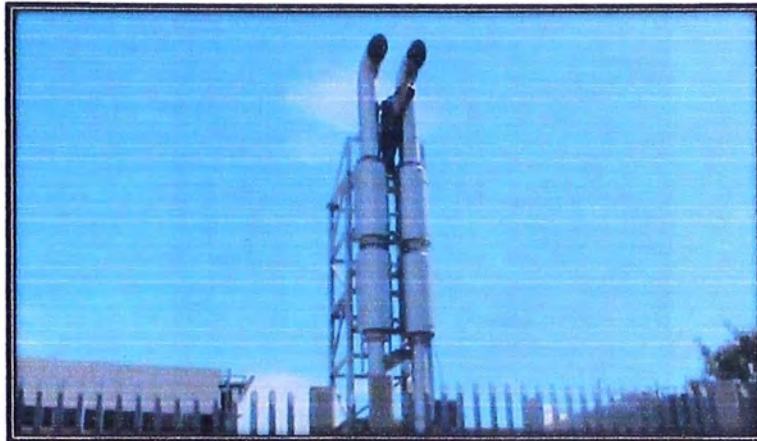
Culminación de montaje de primera y segunda línea tubería de escape de 10" Ø" con resonadores de 12" Ø con las mallas en la salida de escape
